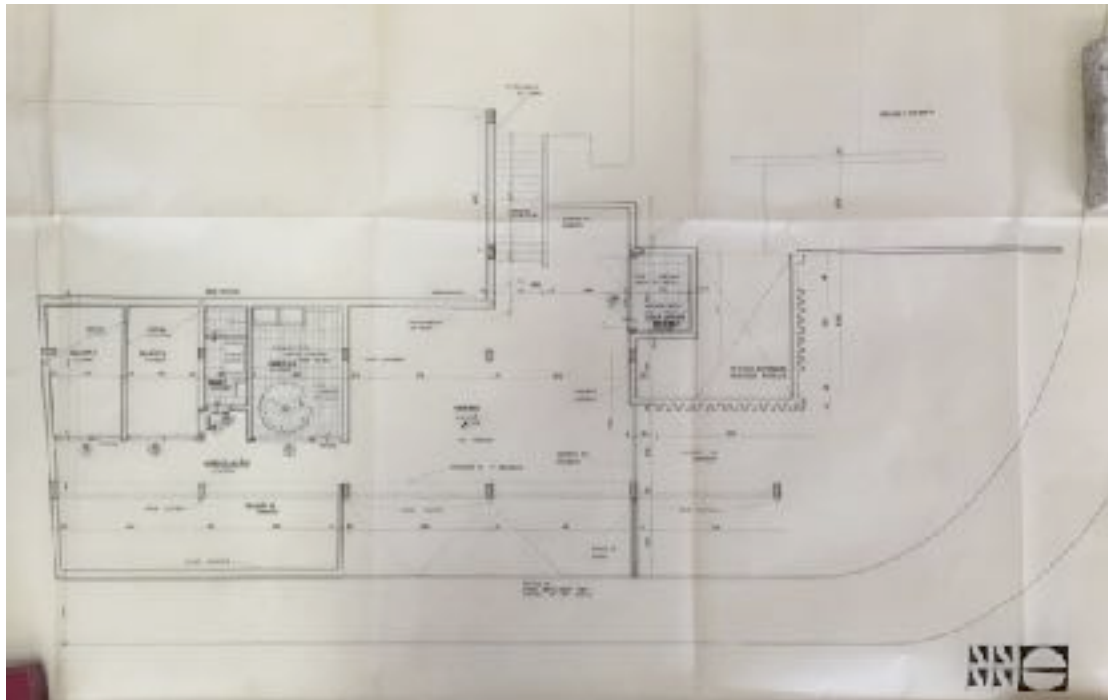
Planta Subsolo Residência Fernando Monteiro. Fonte: NPD FAU UFRJ.
